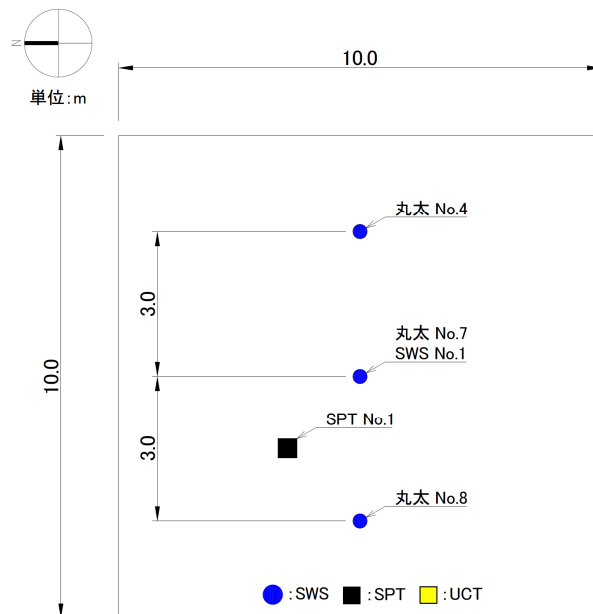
配置図と地盤調査位置: 全体 (A0 地点: 秋田県大湯村)
